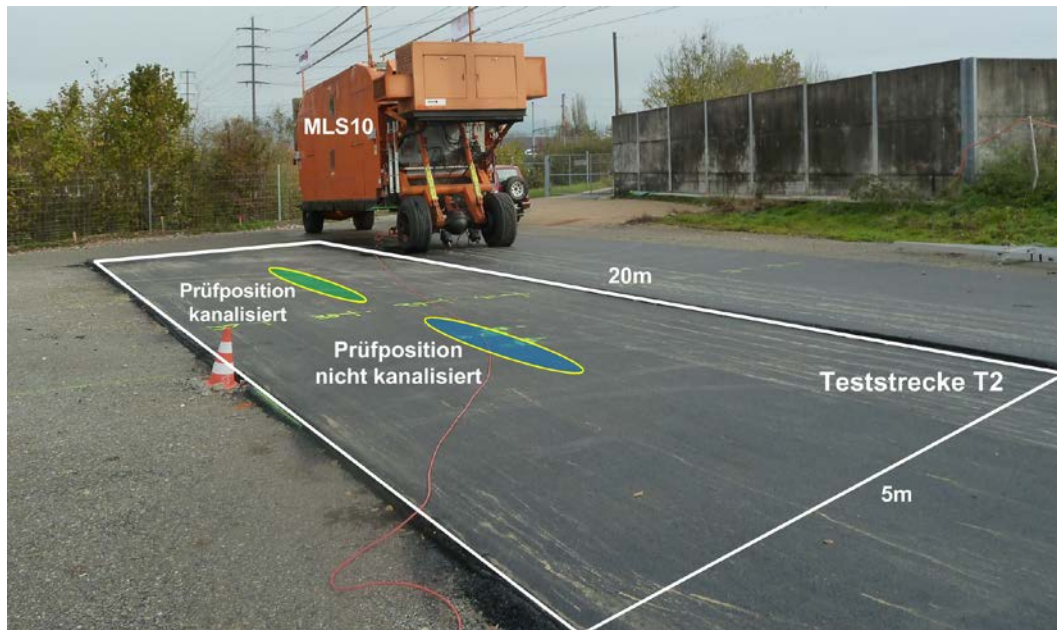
Fertig eingebaute Teststrecke mit markierten Prüfpositionen
